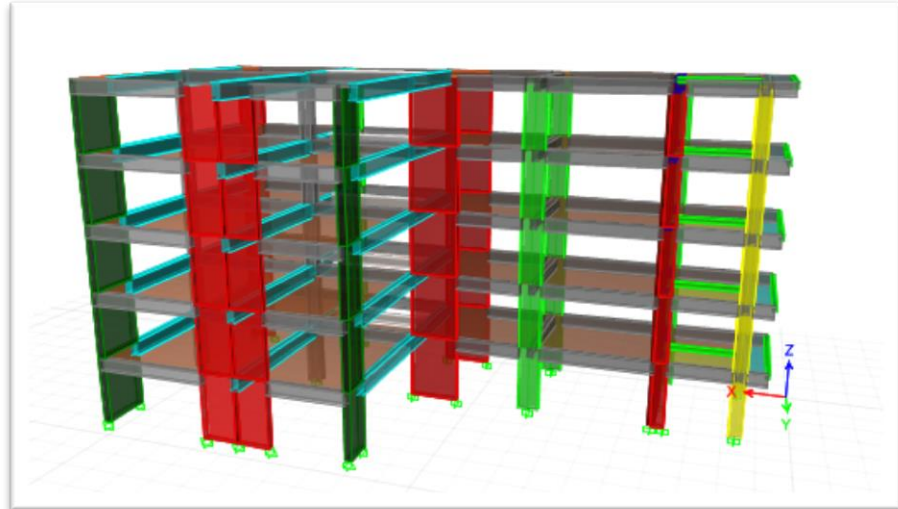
Modelamiento estructural de la edificación. Fuente propia
